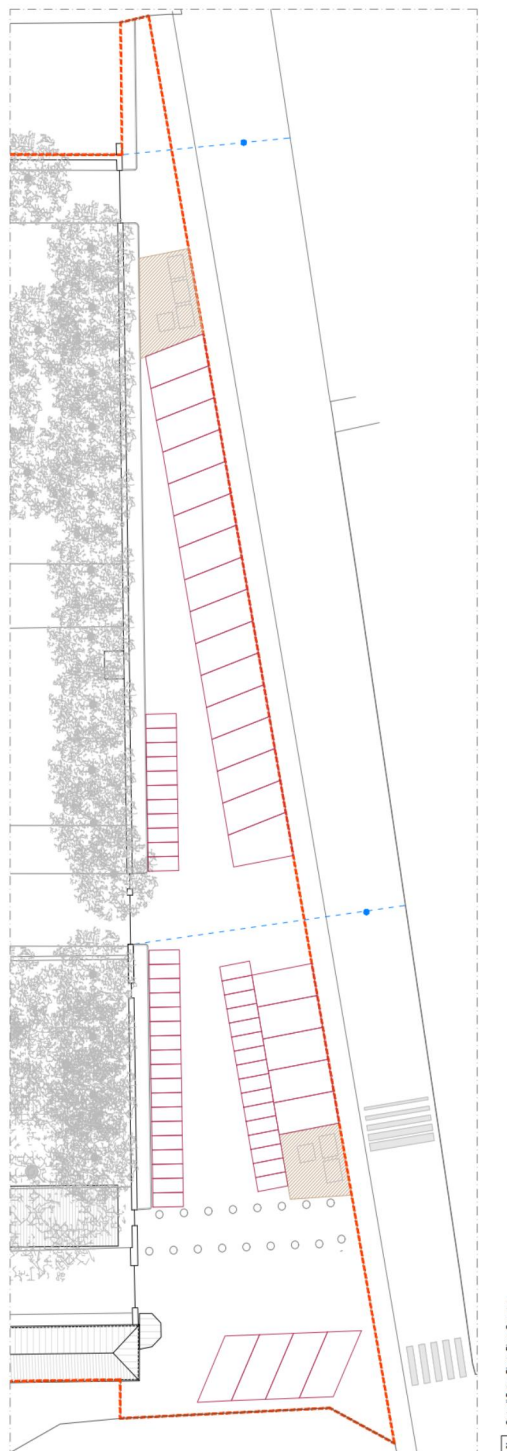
planimetria parcheggio esterno riviera Paleocapa
